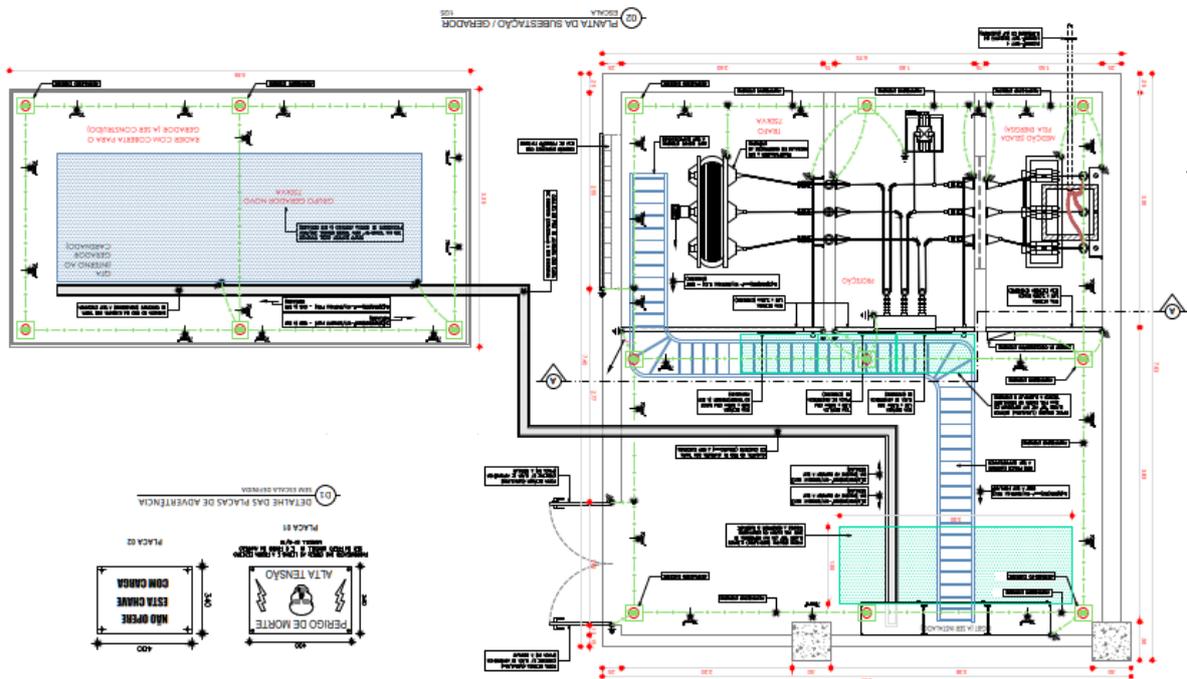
Layout da subestação e grupo gerador em radier após as intervenções
